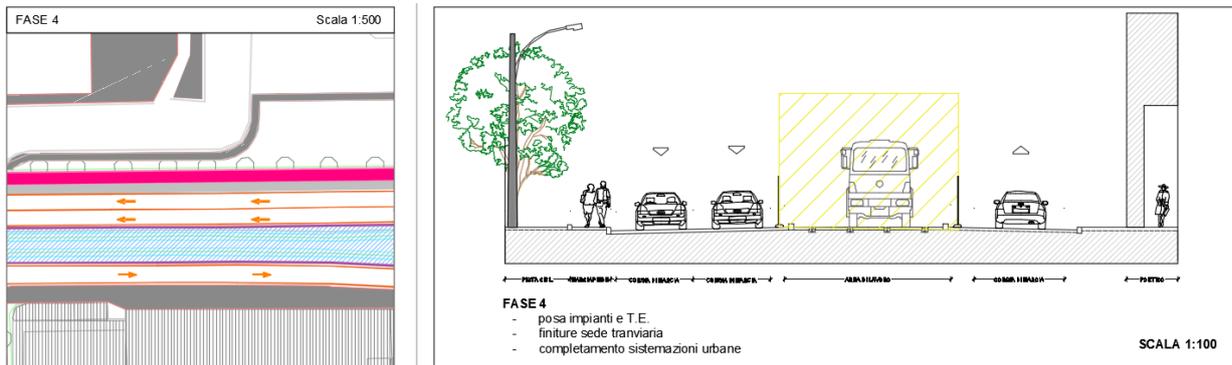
Tipologico cantiere con sede centrale Fase 4
